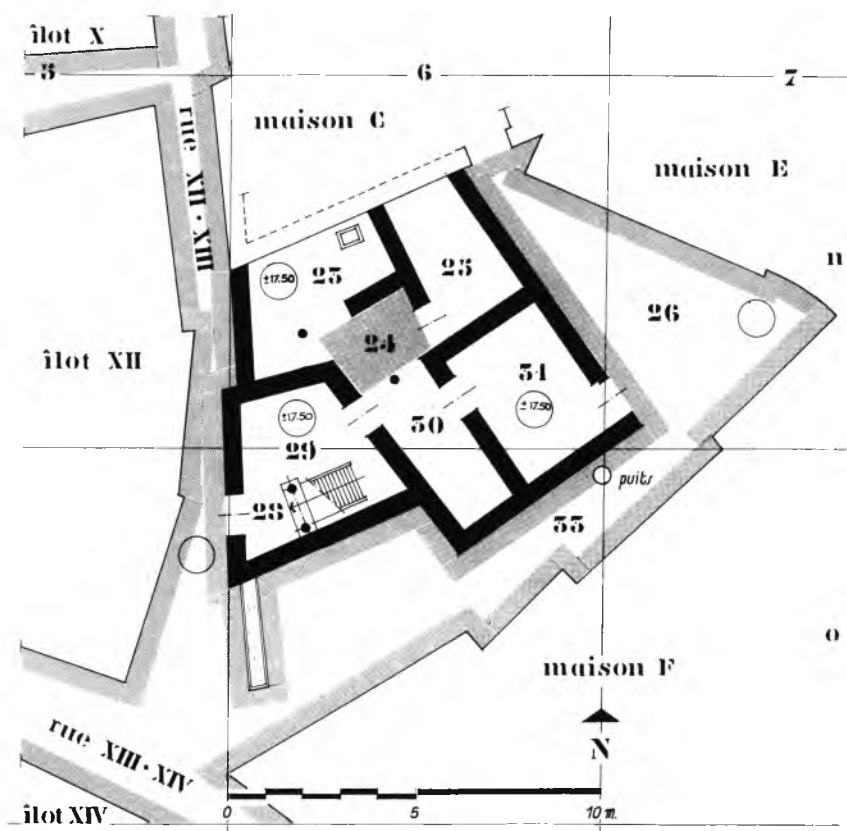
Îlot XIII : Maison D : essai de reconstitution du plan du rez-de-chaussée.
